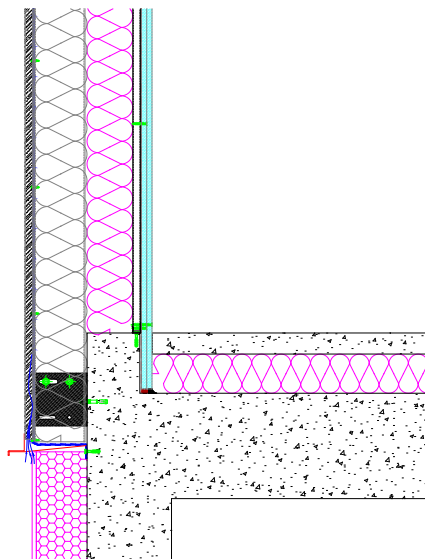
Liaison Façade F4 / Plancher bas isolé sous chape avec 93 mm d'isolant EPS SOL PLUS
